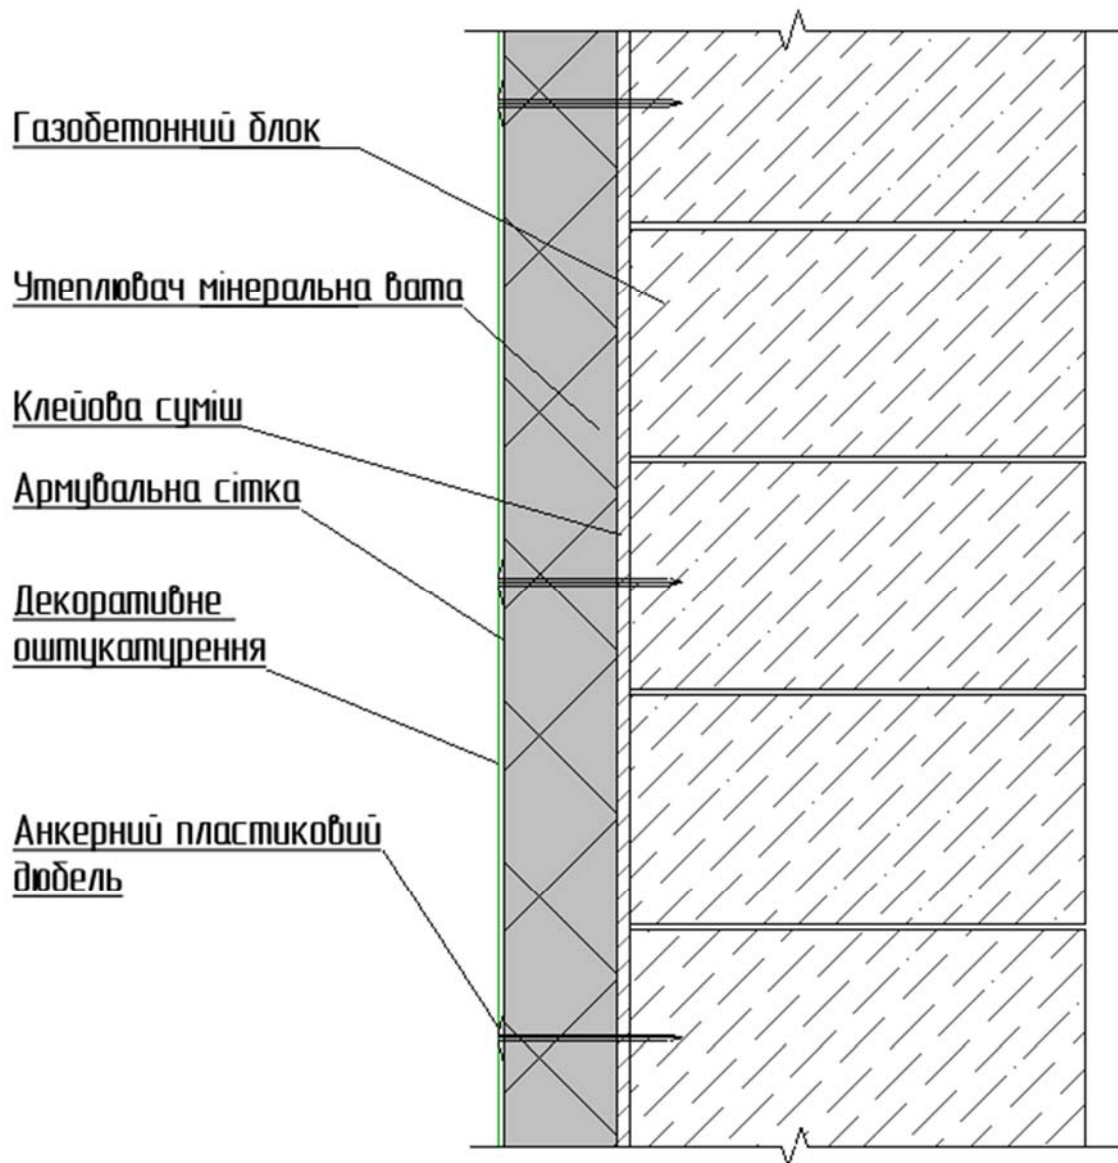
Вузол утеплення кладки газобетонних блоків
